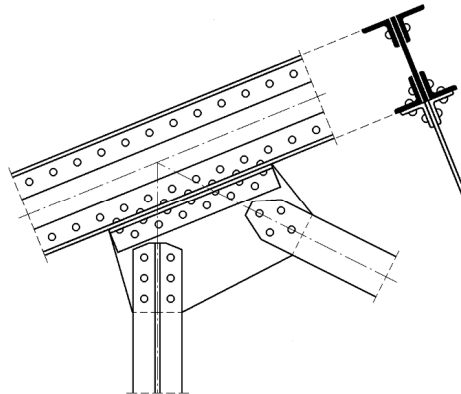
Beispiel für ein Konstruktionsdetail mit Halbrundnieten
